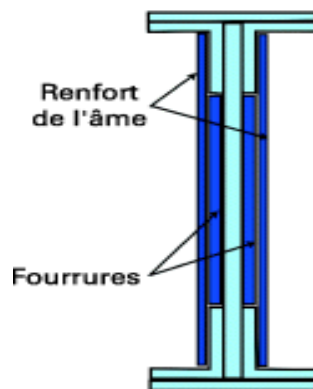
Principe de renforcement de l'âme d'une poutre endommagée [9]
